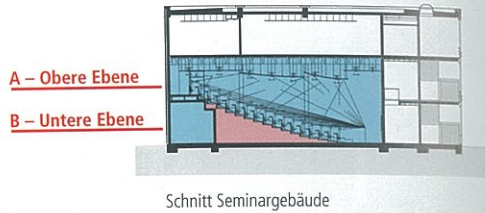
Zu 6.1.1 Brutto-Grundfläche (BGF) – Inhalt und Abgrenzung (3) Flächen zur Wartung, Inspektion und Instandsetzung
